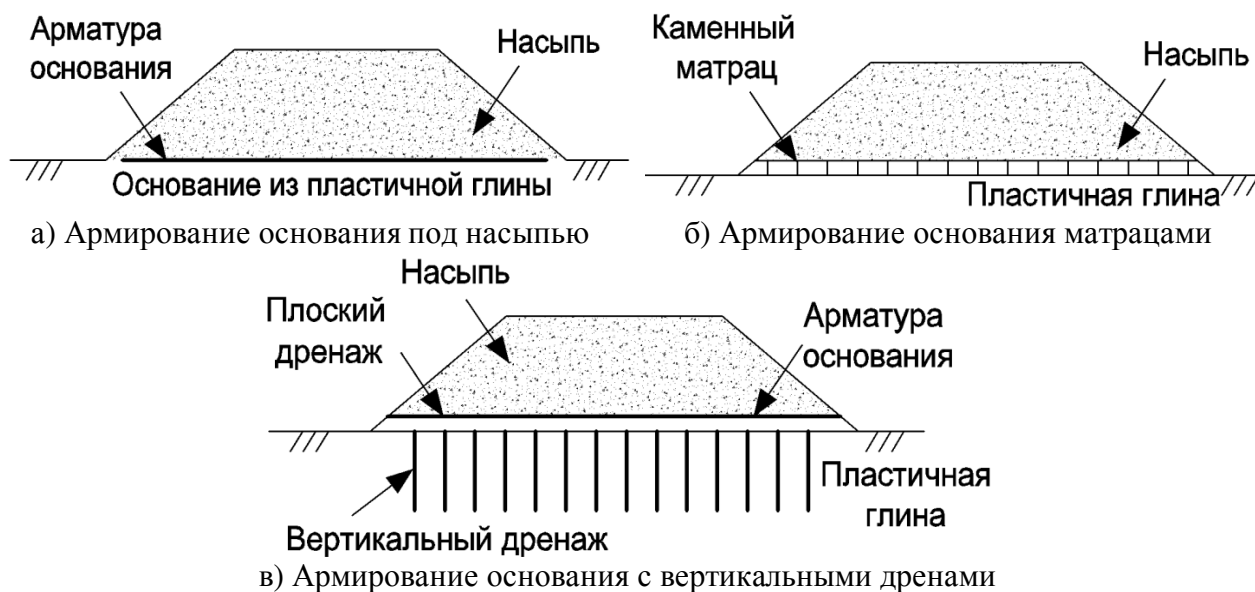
Армирование основания для повышения устойчивости насыпи с начального момента строительства
